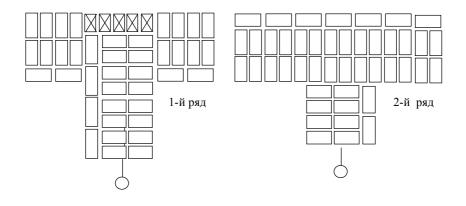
Кладка примыканий стен толщиной в 2 кирпича
